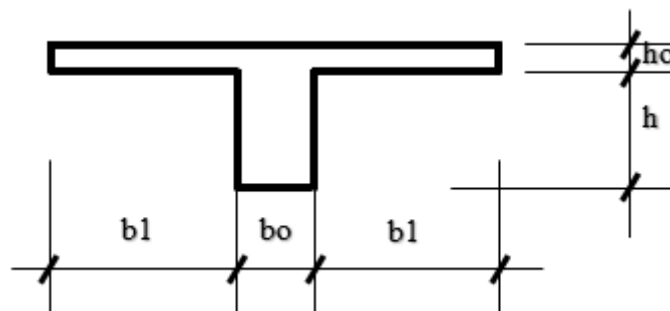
Notations utilisées pour la poutrelle d'un plancher corps creux type
